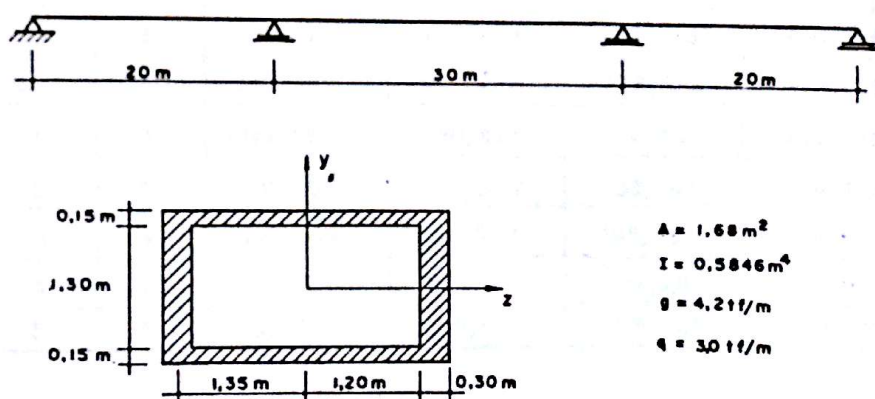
ESQUEMA DA VIGA E CARACTERÍSTICAS DA SEÇÃO
